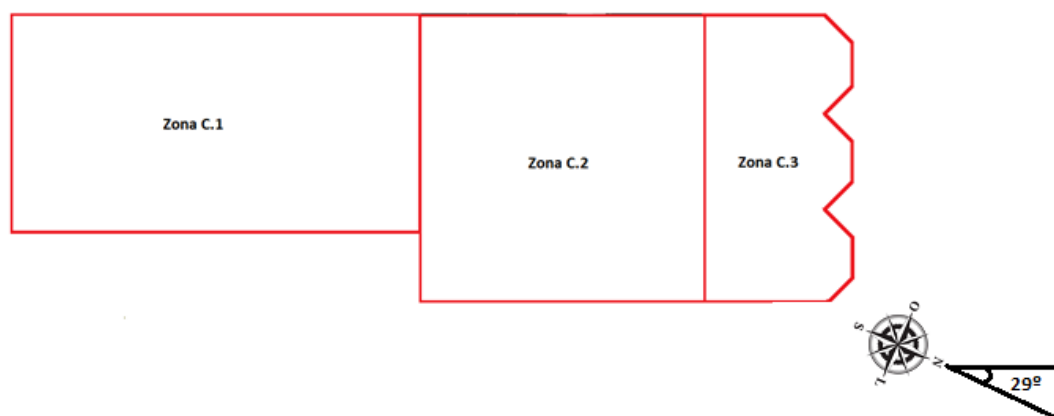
Divisão das diferentes zonas da Cave (Piso cave).
